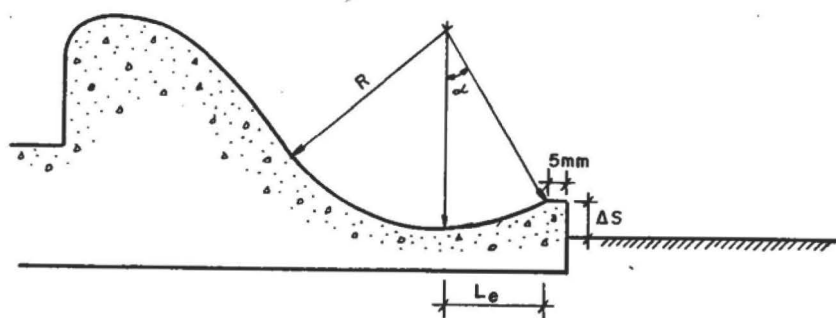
Croquis dos parâmetros das estruturas ensaiadas
